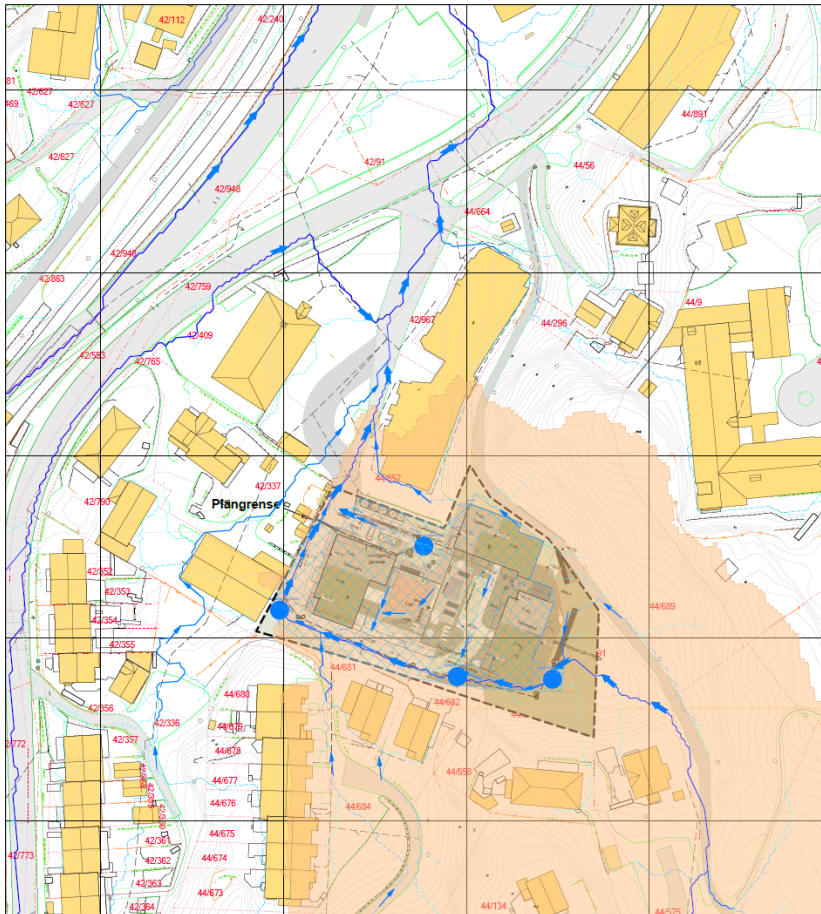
Illustrasjonsplan med angitt plassering av blå struktur.
